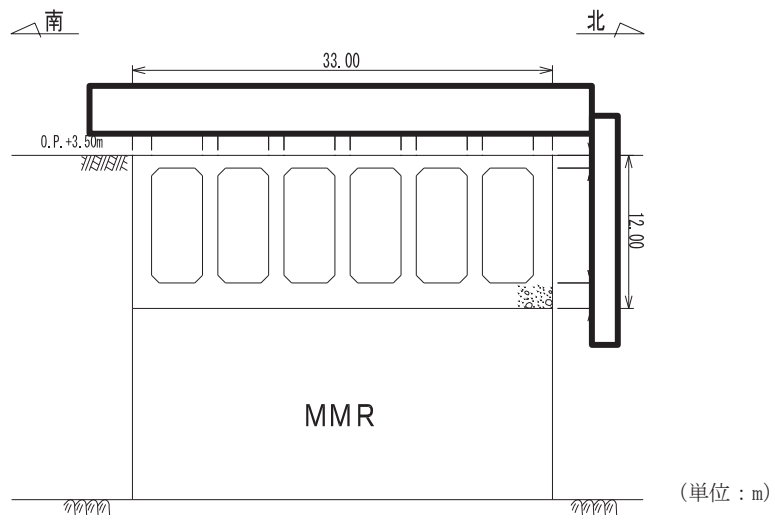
取水口断面図 (A-A 断面, 南北 (標準部))
